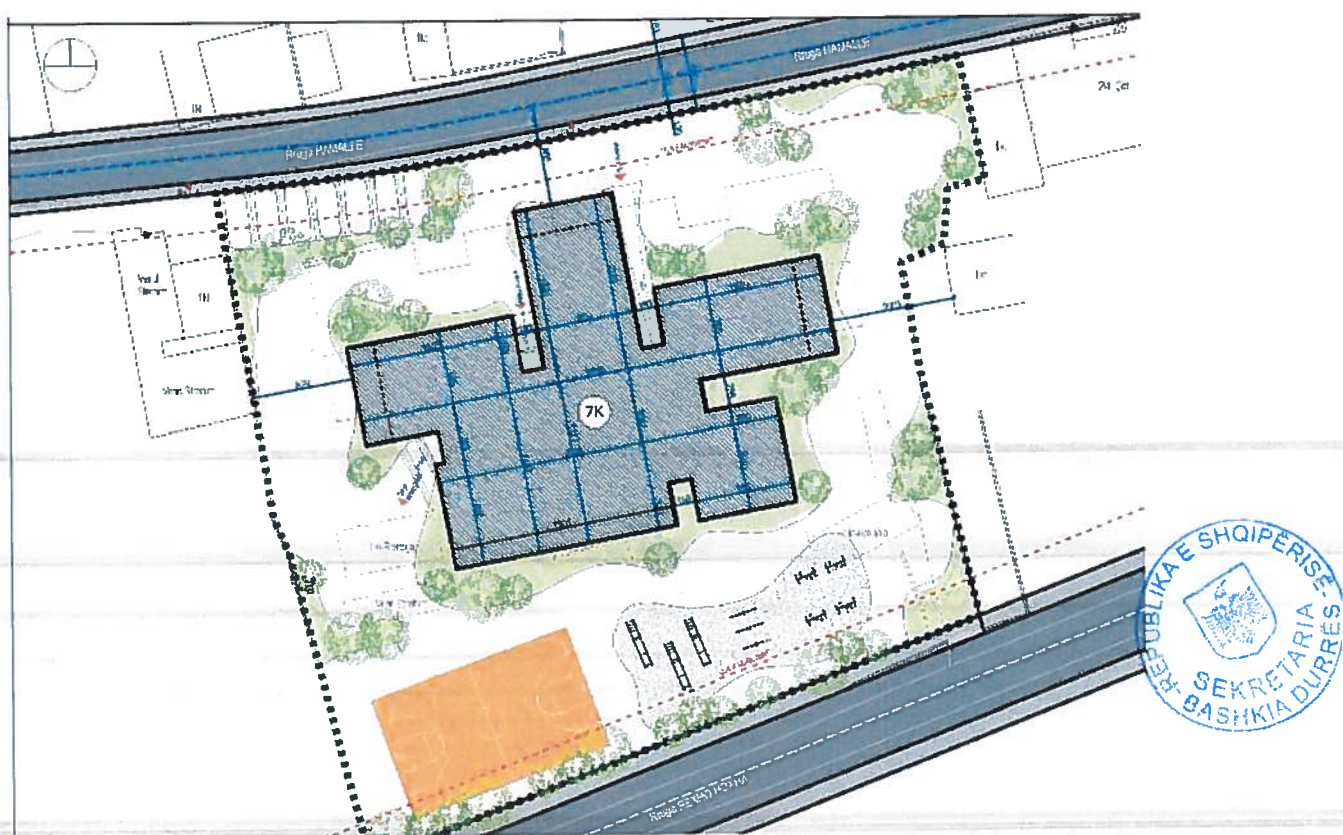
Planvendosja e objektit të ri të propozuar në Zonën Hamallaj
